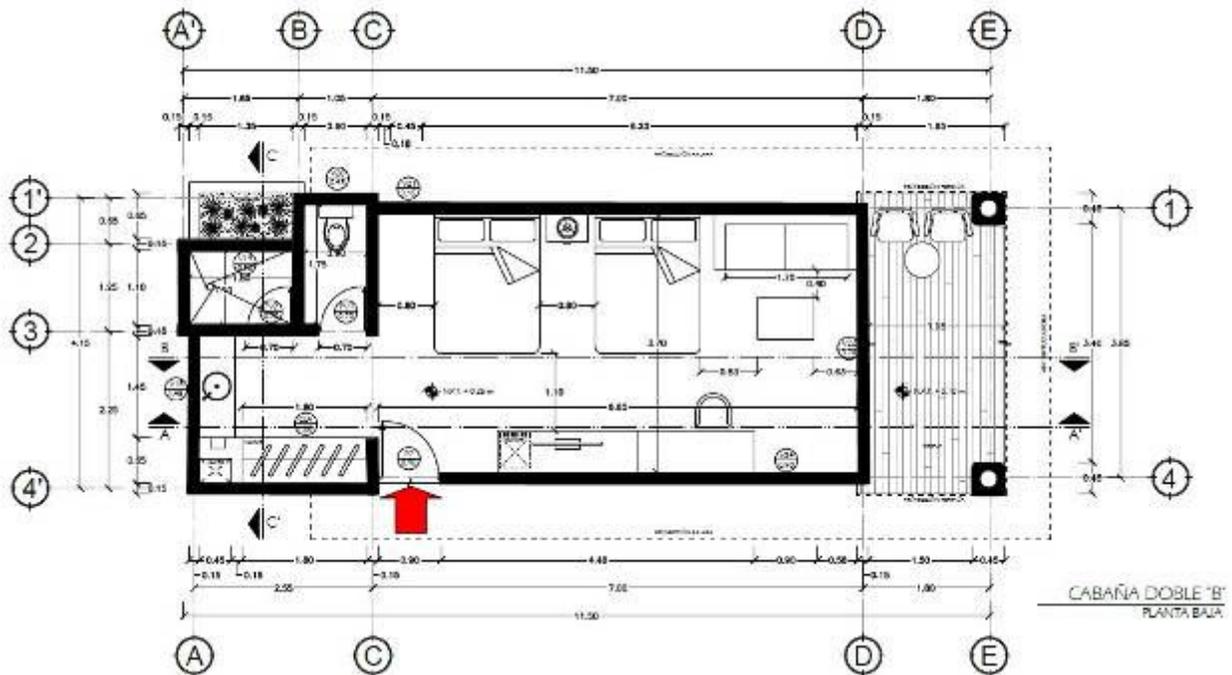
Planta de Cabaña Tipo B Doble. (Flecha roja: Acceso directo en planta baja). La escalera no se muestra por ser parte de la estructura del tanque elevado.
